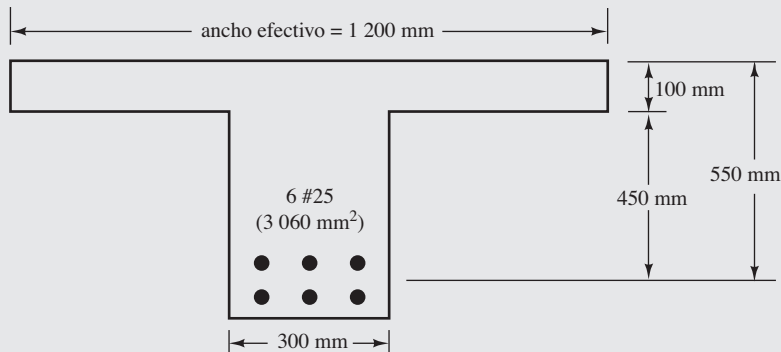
Sección transversal de la viga del ejemplo 5.11.
